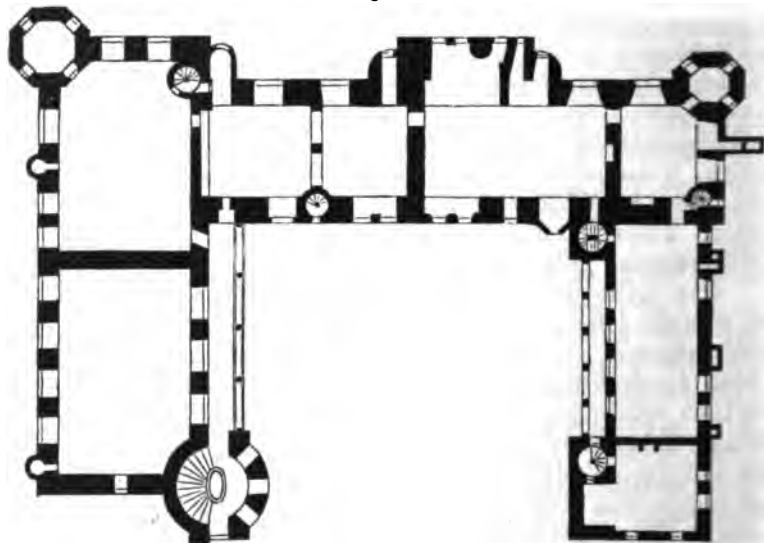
Grundriss des Schlosses zu Güstrow.
